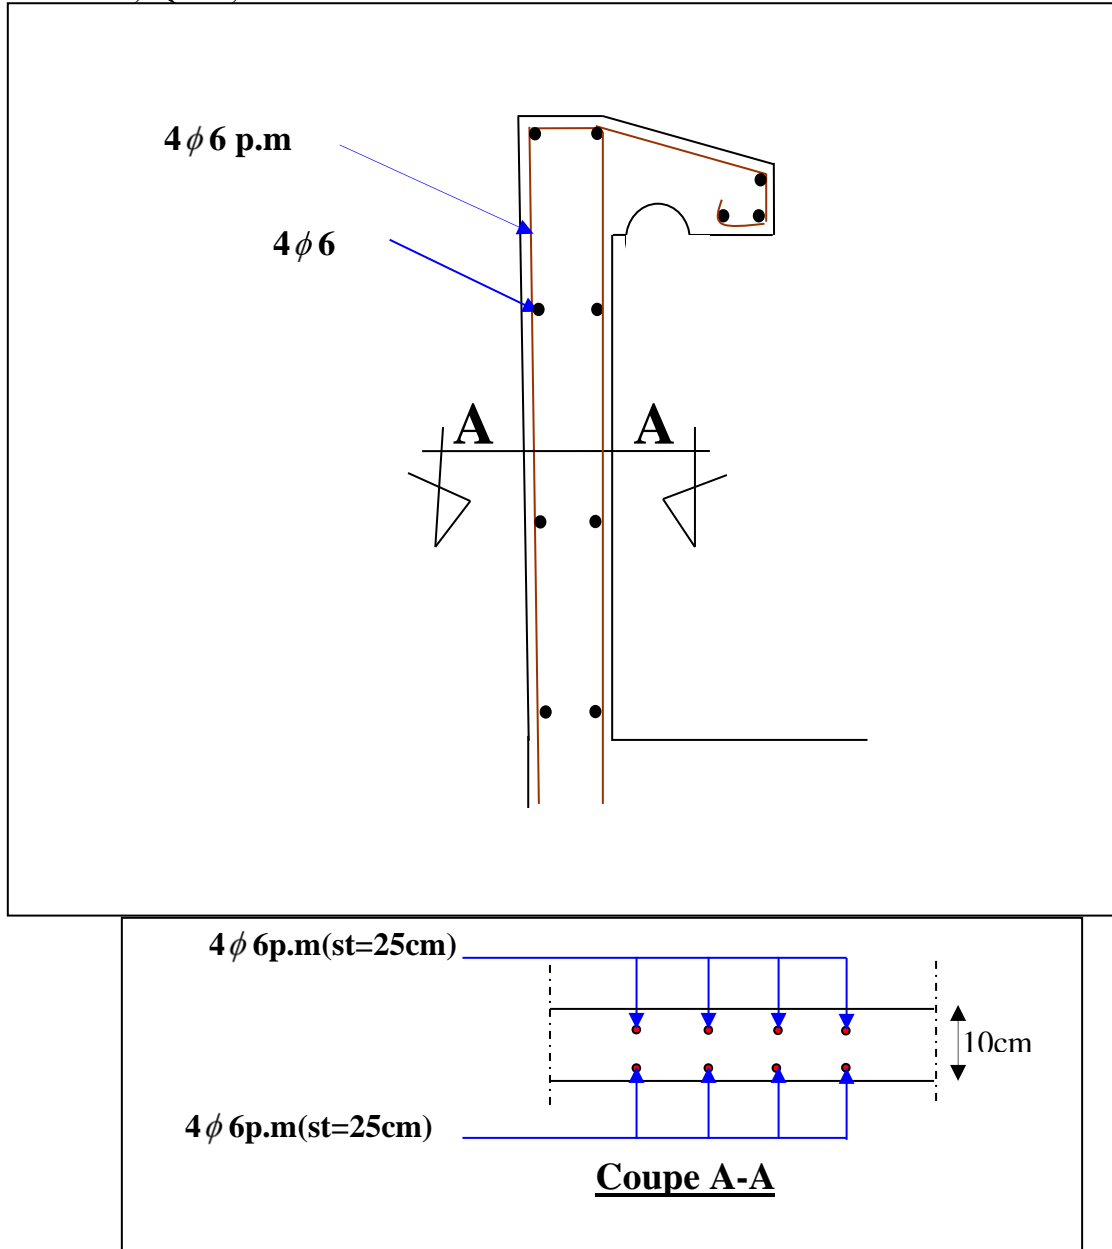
Schéma du ferrailage de l'acrotère.
